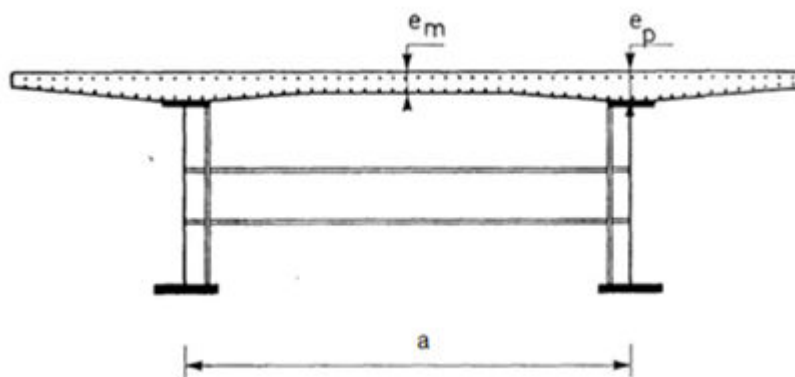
Coupe transversale d'un ouvrage à entretoise
